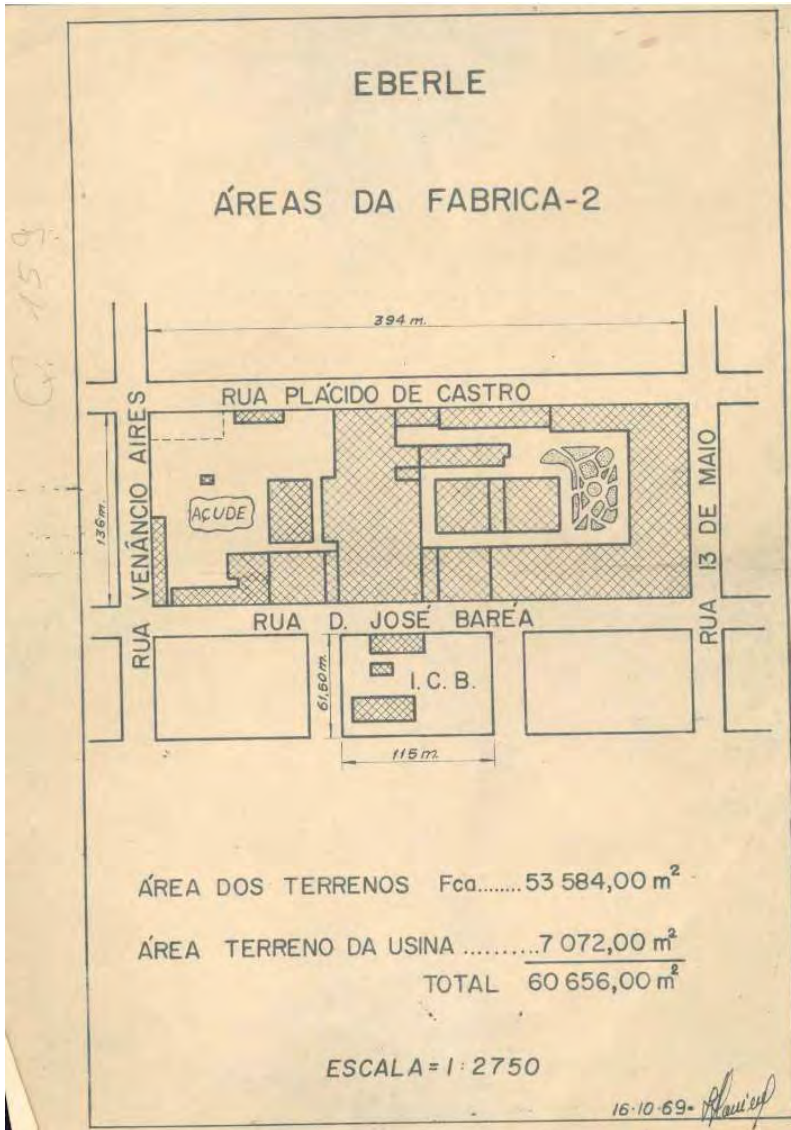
Prancha 02: Planta de Situação dos terrenos
